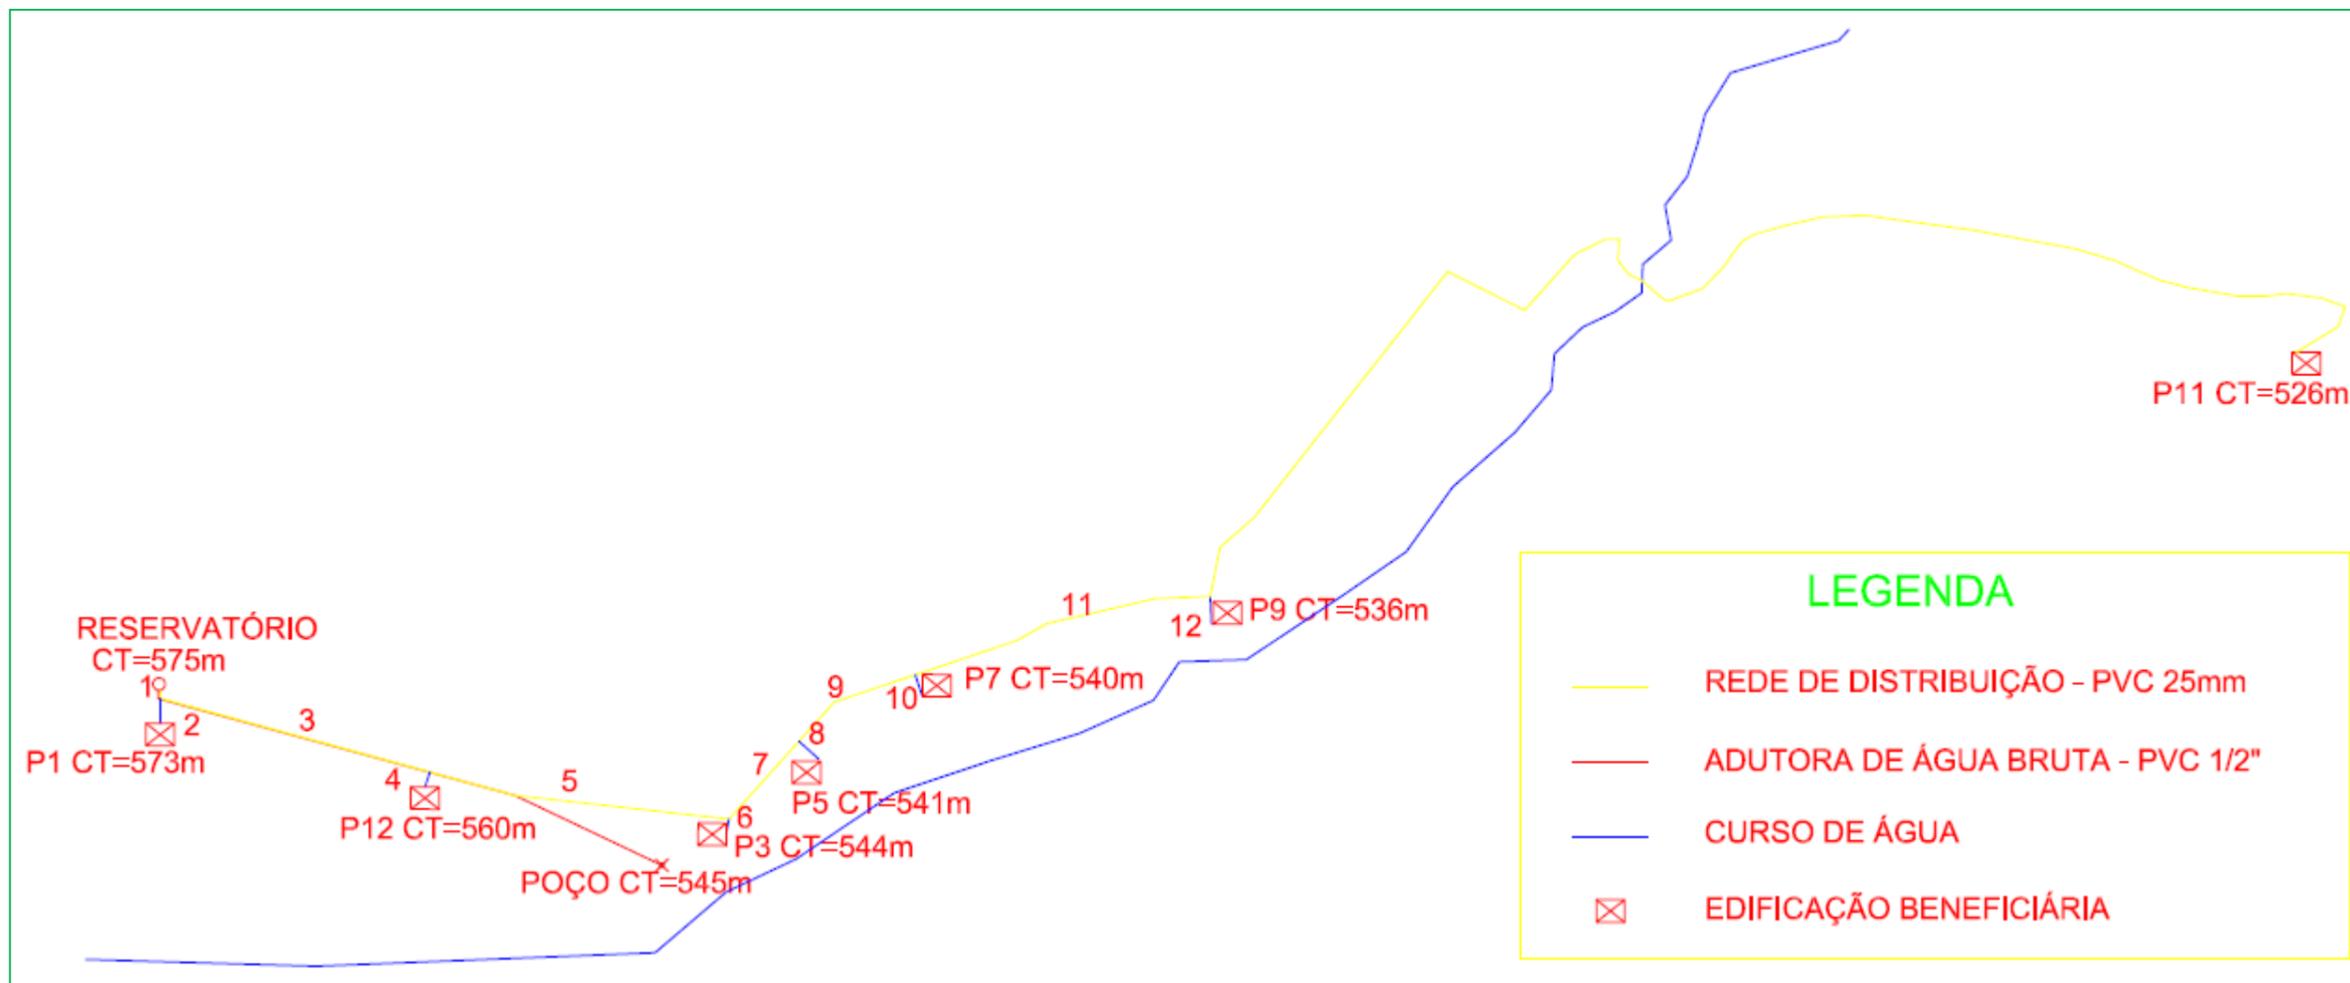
Planta SSAA – Solução Captação Subterrânea por Poço Tubular Profundo.
